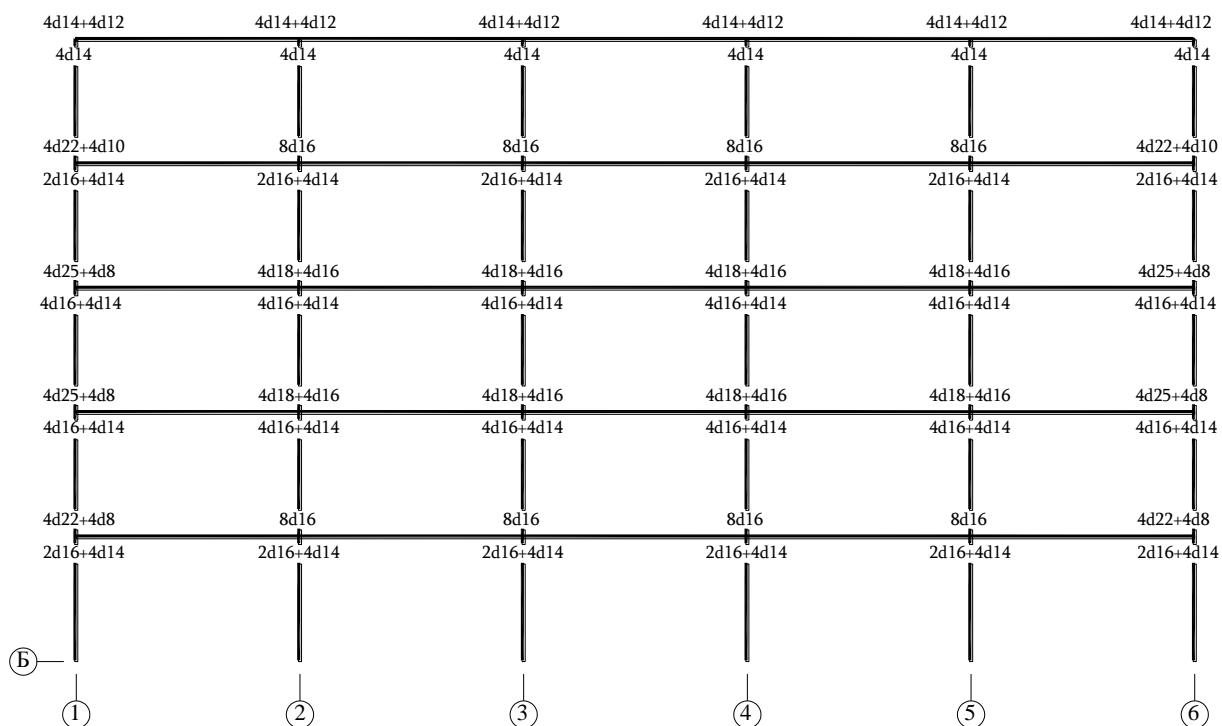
Продольное армирование балок рамы, расположенной по оси Б, в соответствии с результатами конструирования:
